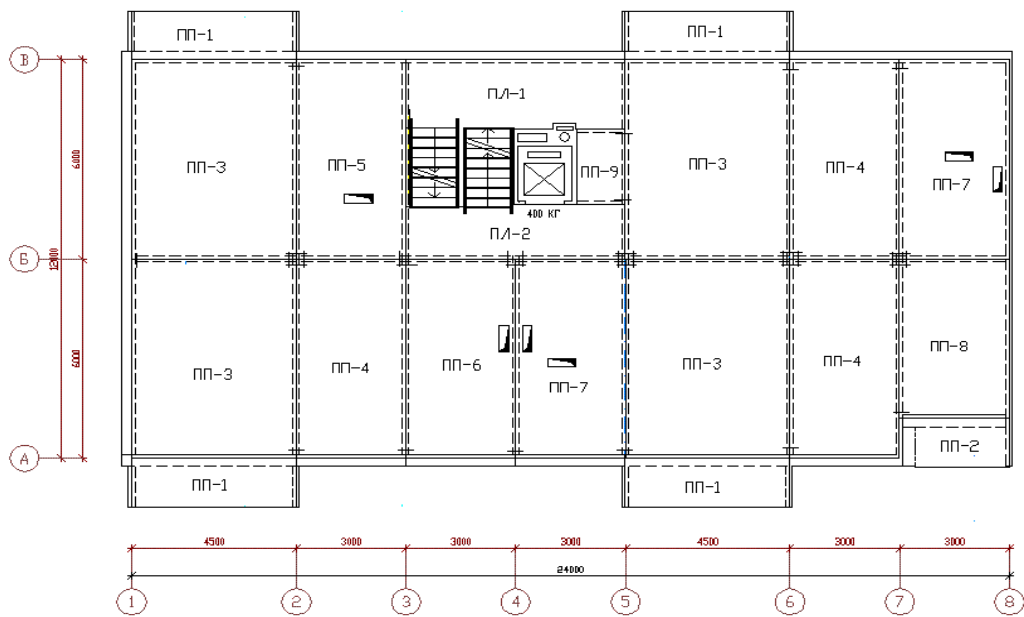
План перекрытия бескаркасного крупнопанельного здания
